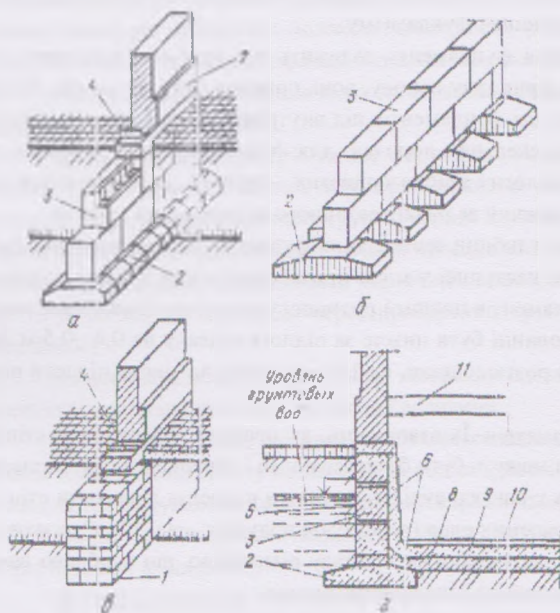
Стрічкові і переривисті фундаменти: а – стрічковий збірний за відсутності підвалу; б – переривистий збірний; в – стрічковий з будового каменя; г – стрічковий за наявності підвалу і високого рівня ґрунтових вод; 1 – підшва фундаменту; 2 – залізобетонні блоки-підушки; 3 – залізобетонні блоки фундаментів; 4 – гідроізоляція; 5 – обмазувальна гідроізоляція; 6 – обклеєна гідроізоляція; 7 – цоколь; 8 – бетонна підготовка; 9 – залізобетонна плита; 10 – пів; 11 – перекриття
